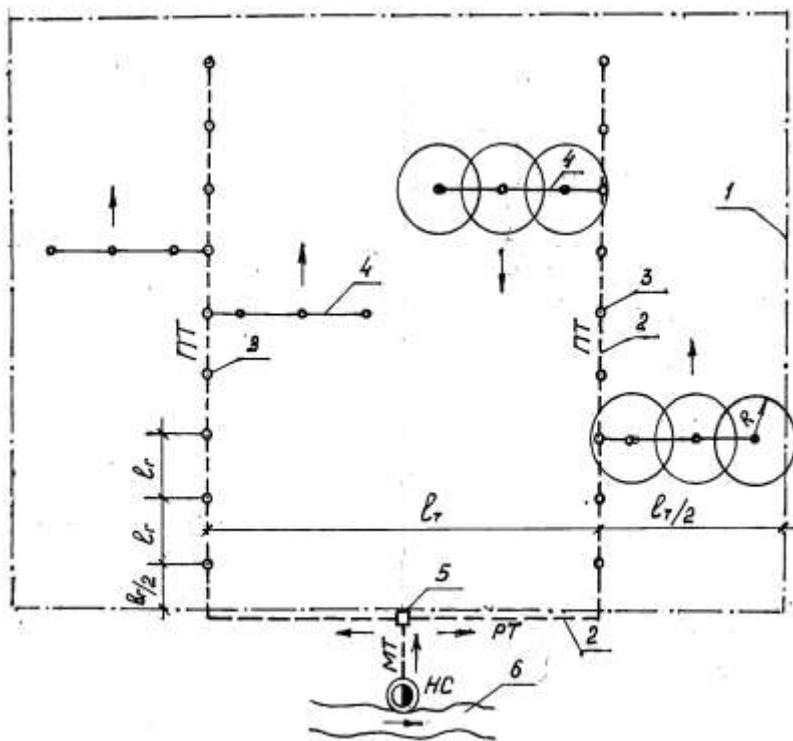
Схема орошения дождевальными агрегатами:
